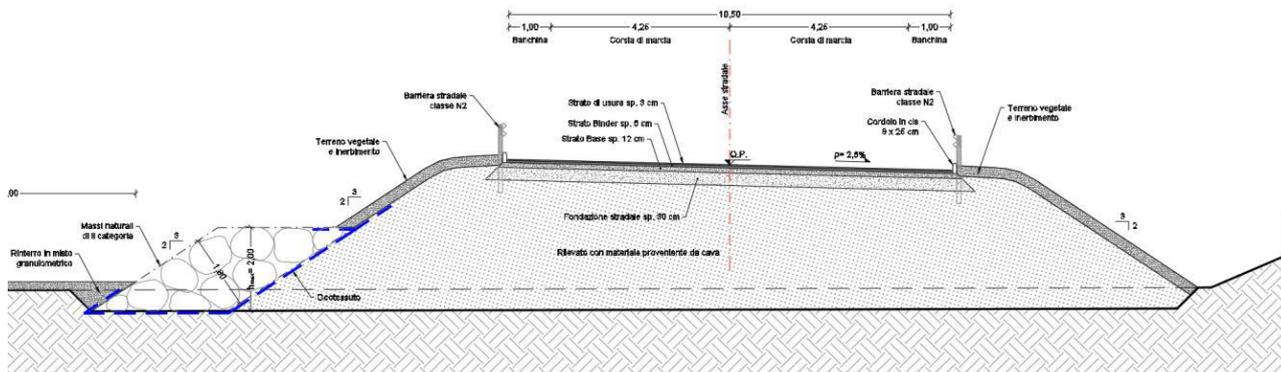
Raccordo di collegamento porto - SS18. Sezione tipologica viabilità di progetto
